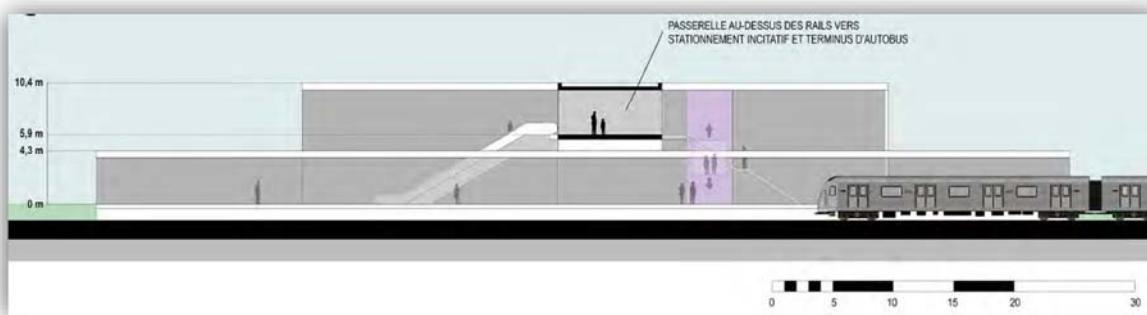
Coupe longitudinale de la station terminale Rive-Sud
